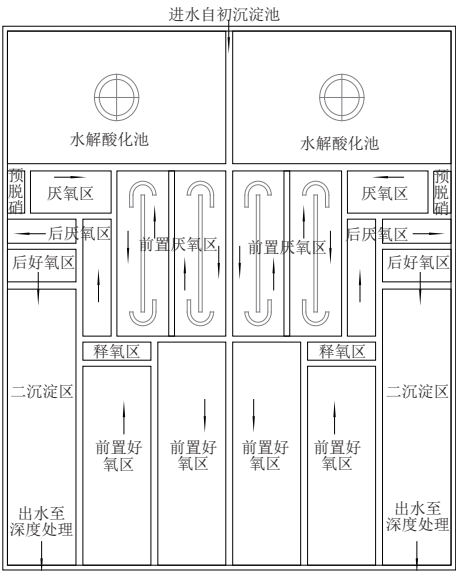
水解酸化池+五段 Bardenpho+沉淀池组合池平面图
